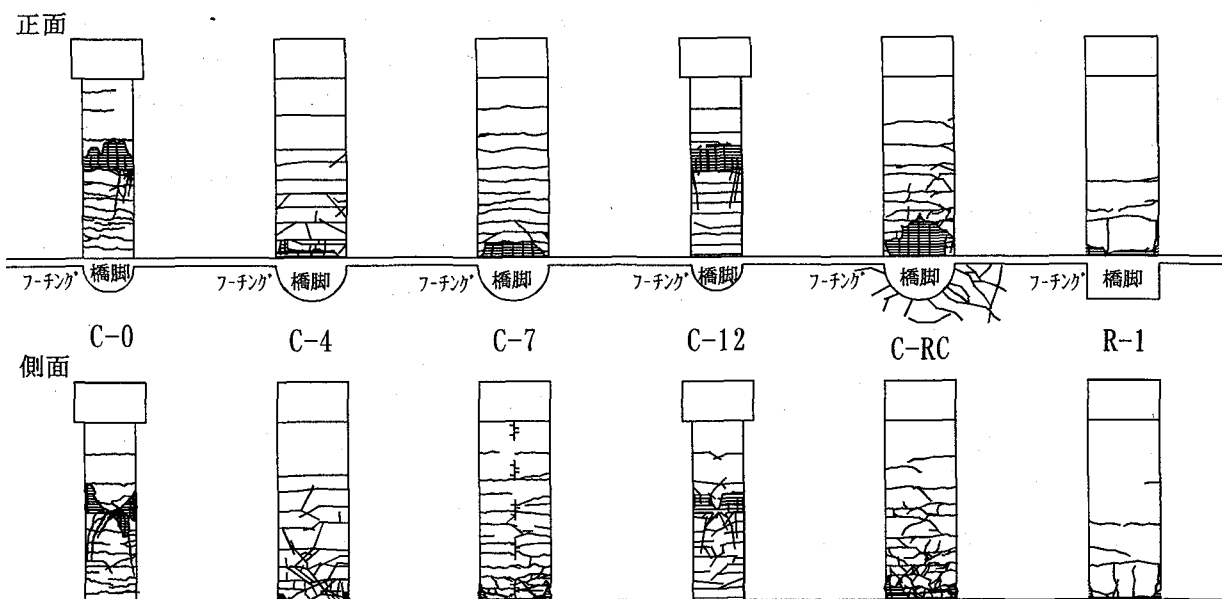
代表的供試体の試験終了時のひび割れおよび破壊状況
